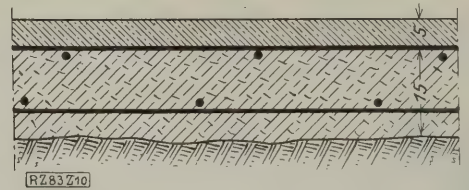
Eisenbetonpflaster, zweifach bewehrt.
